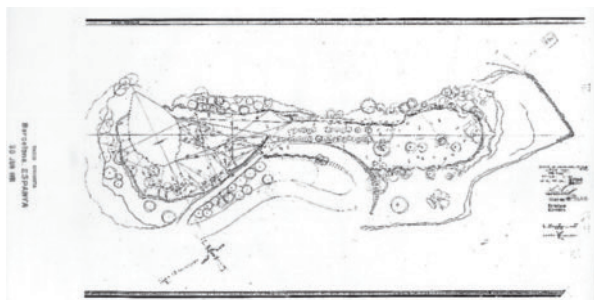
Site plan; 遺構 (1989) 敷地配置 (S=1/200)
